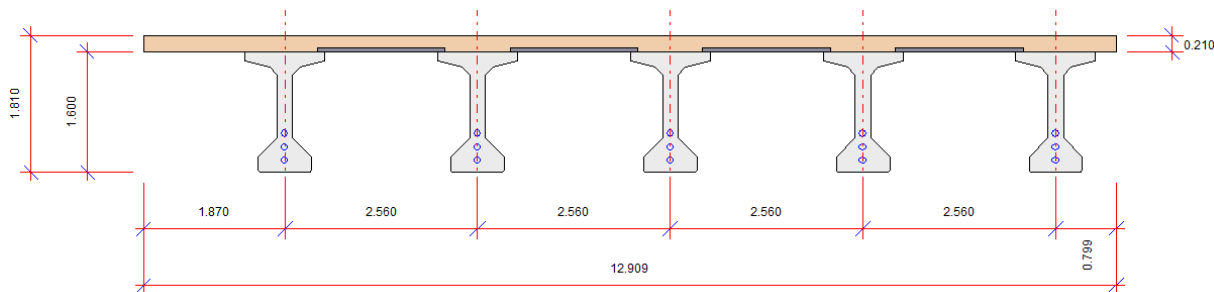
Sección tipo. Fuente: IDOM-DEHC.
